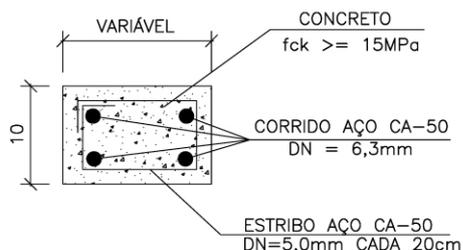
Detalhe da seção transversal da verga em concreto armado
